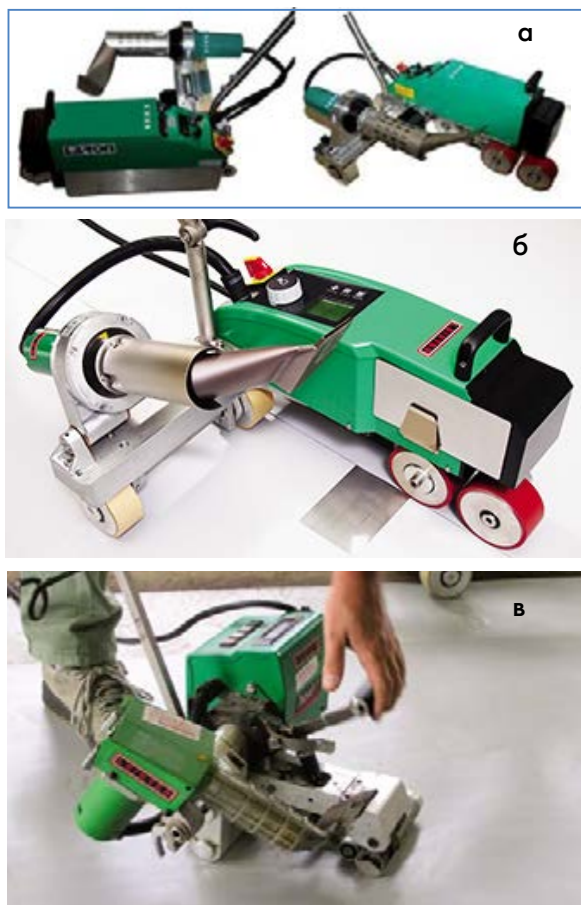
Автоматическое сварочное оборудование
